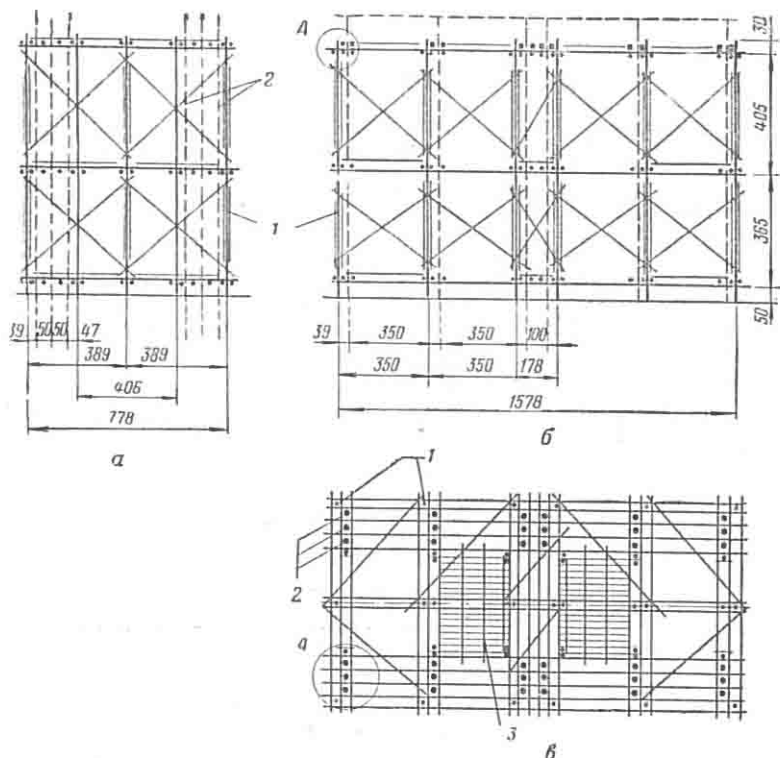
Схема деревянного каркаса для основания с вертикальными сваями под опору с пролетными строениями $l = 55,0$ м:
